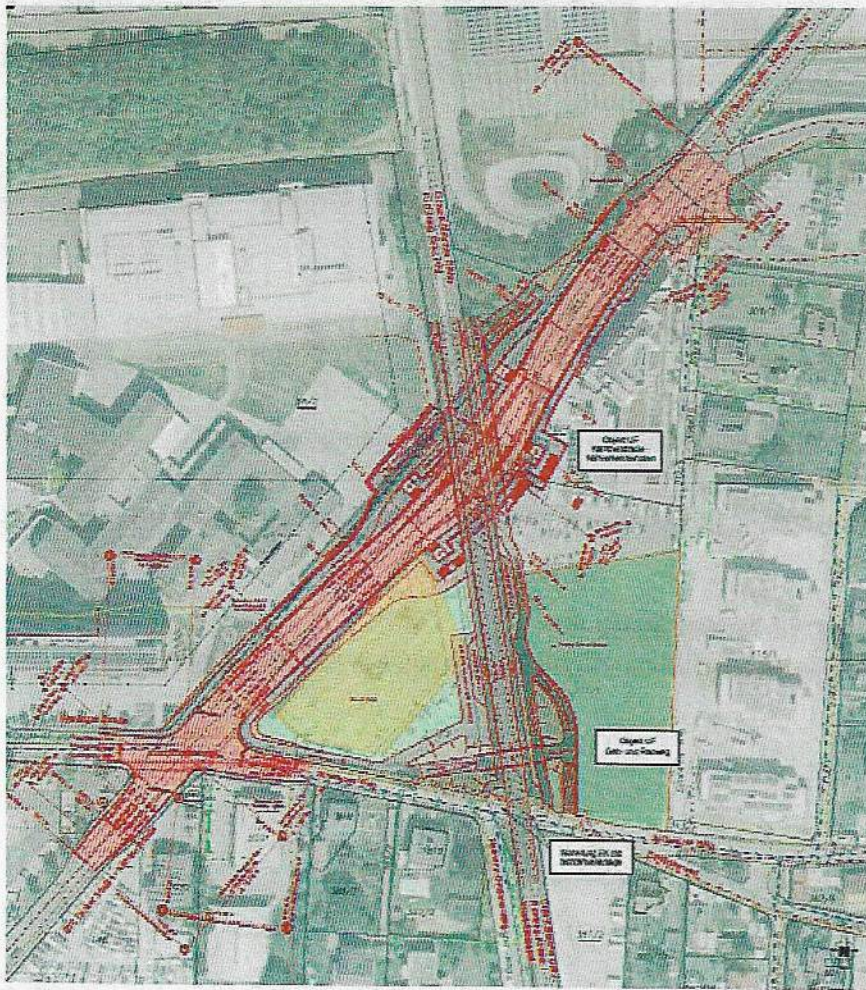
Straßenunterführung Kärntner Straße (Planung IKK Engineering GmbH)
